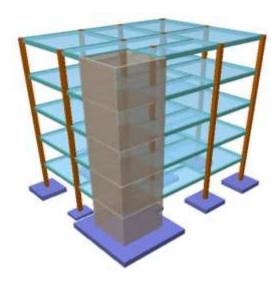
Pórtico de hormigón armado con muro estructural de ascensor. Tomado de (Reyes, 2014).
